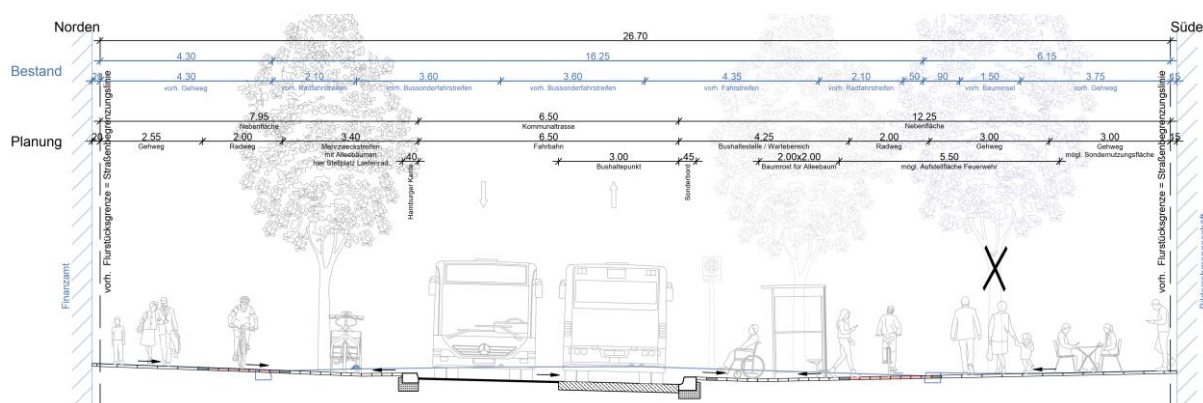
Querschnitt D-D der Ausführungsvariante (Steinstraße vor Haus-Nr. 7/10)
